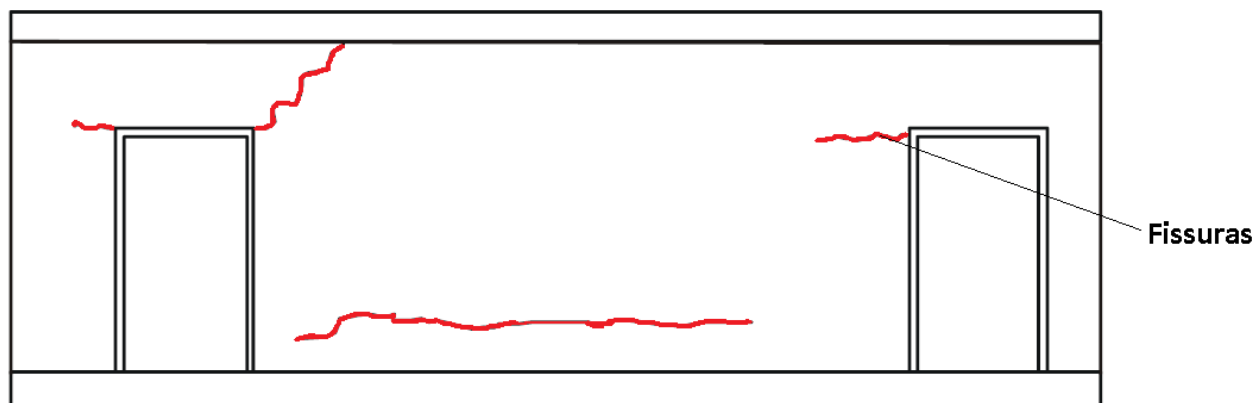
Configuração de fissura quando o elemento de apoio e o elemento superior se deformam igualmente
